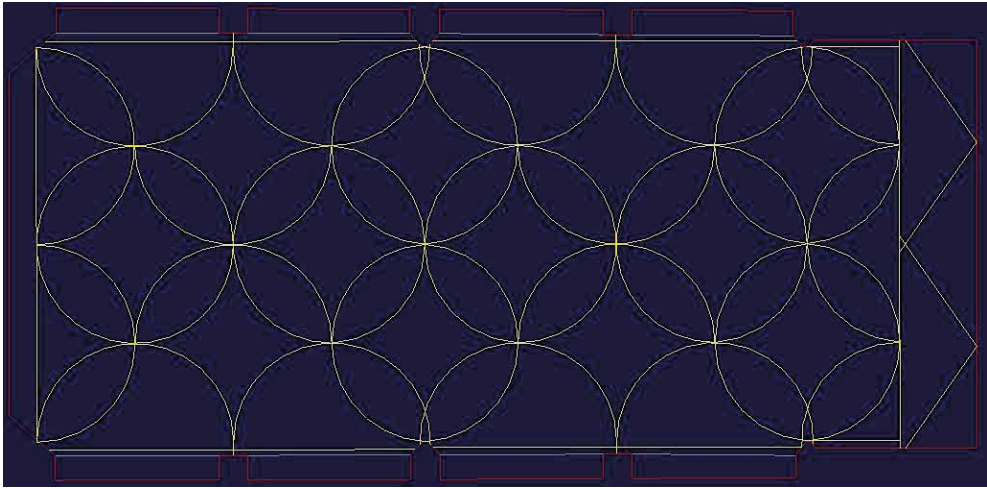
Figuration Wien, vor Ort vermessen und nachkonstruiert © 2010 Thomas Bauer und Jörg Lauterbach
